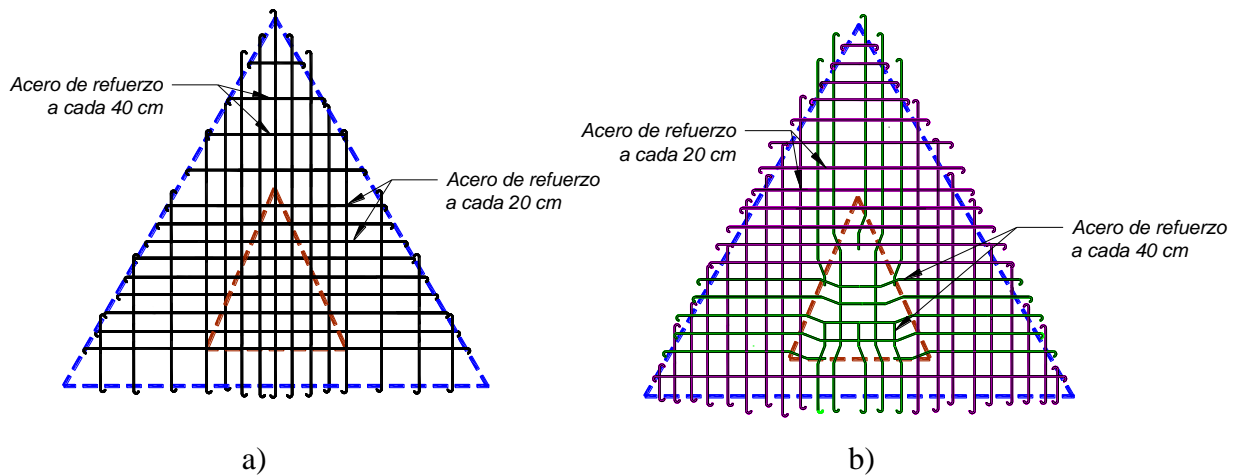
Propuesta del acero de refuerzo en placas triangulares donde: a) refuerzo positivo y b) refuerzo negativo
